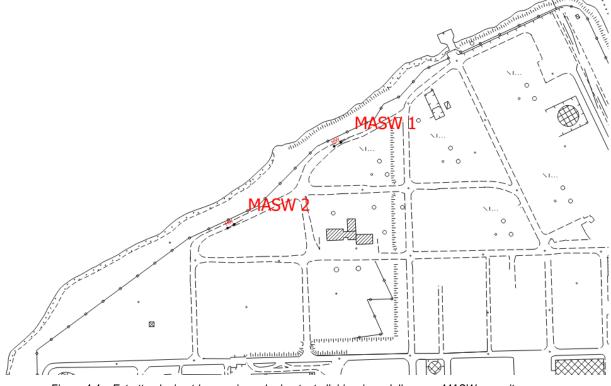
Estratto planimetrico non in scala riportante l'ubicazione delle prove MASW eseguite.
